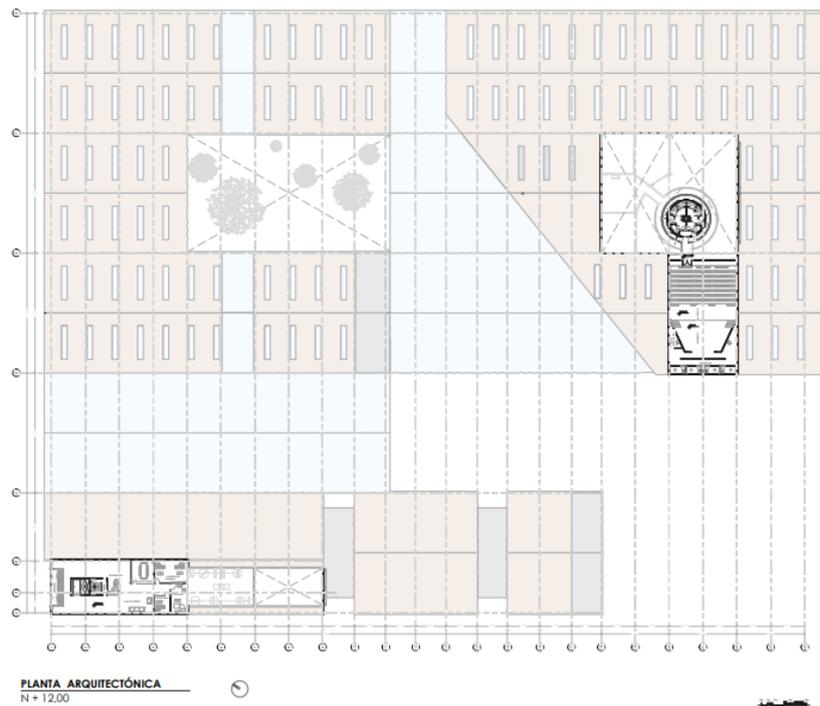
Planta arquitectónica N+12.00 Escuela de Artes - Museo
